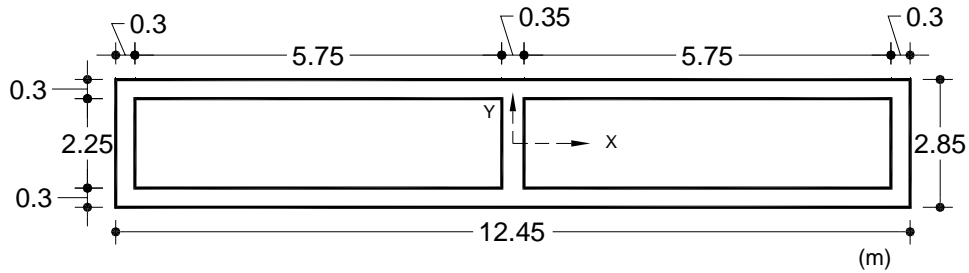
Sección 3 de la columna 3. (No. 6)
